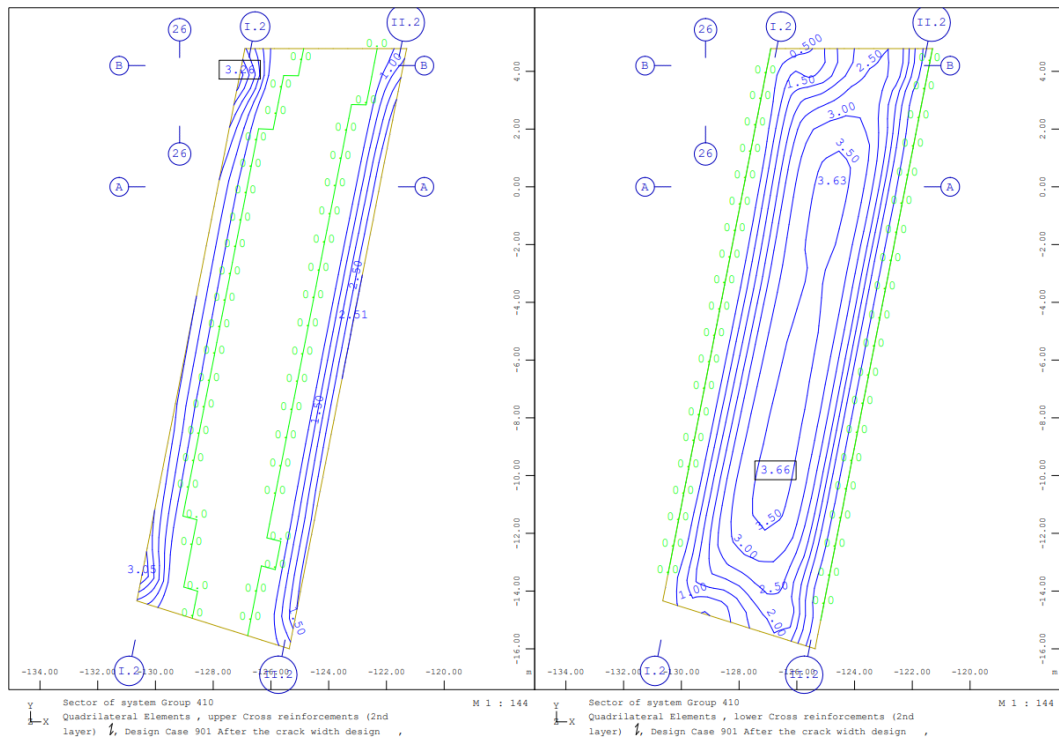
Armadura secundária na face inferior (esq.) e superior (dir.) – laje de fundação – túnel - ELS
